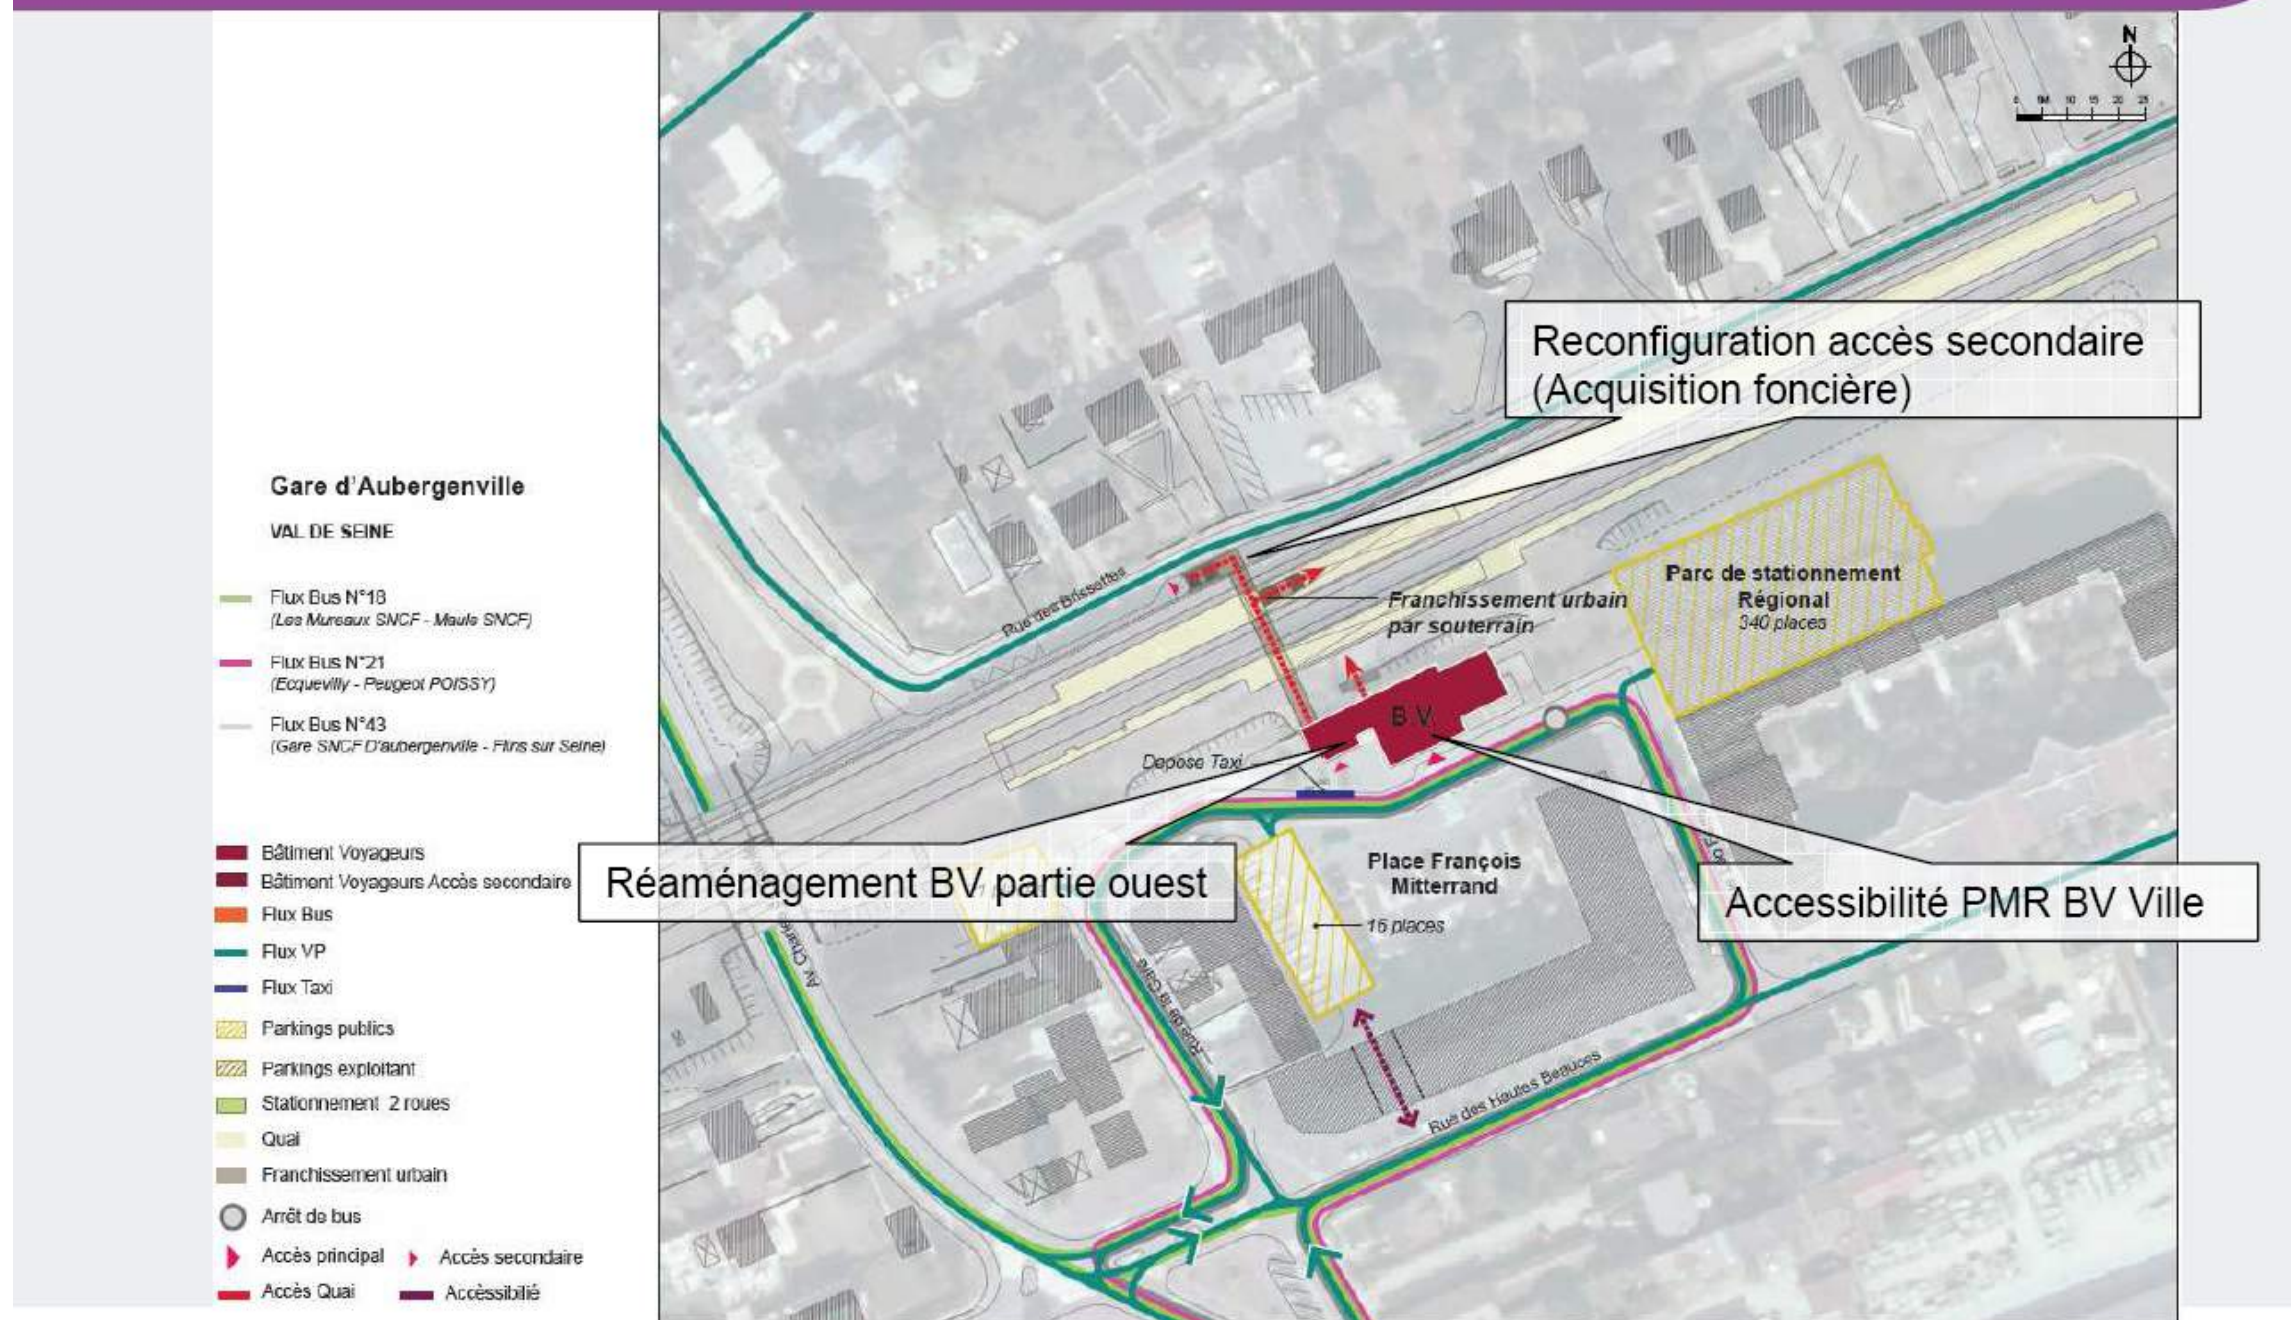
Plan d'aménagement de la gare d'Aubergenville
